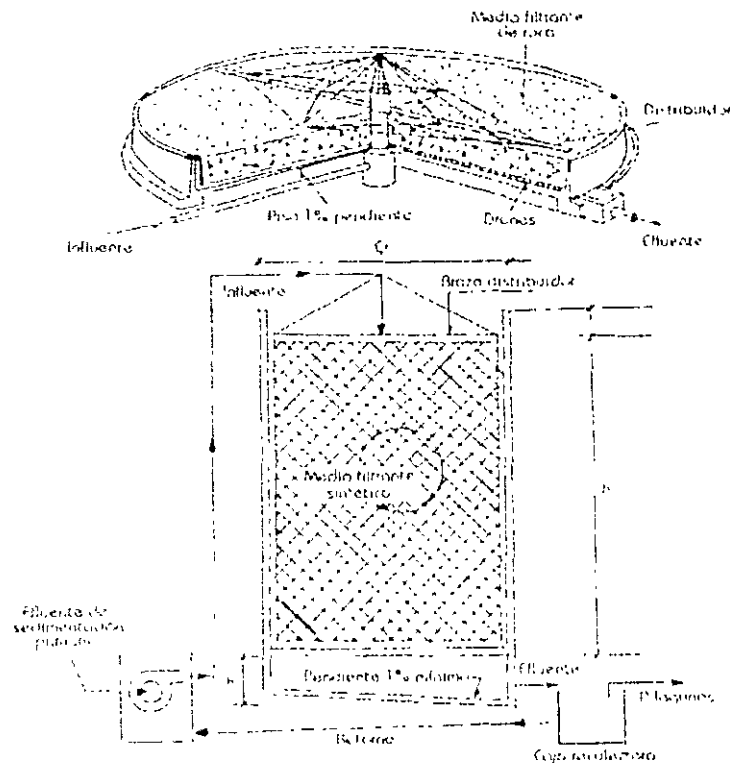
Filtros biológicos: a) horizontal con piedra. b) vertical con medio sintéticos
